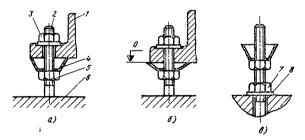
Установка оборудования с выверкой на установочных гайках:
